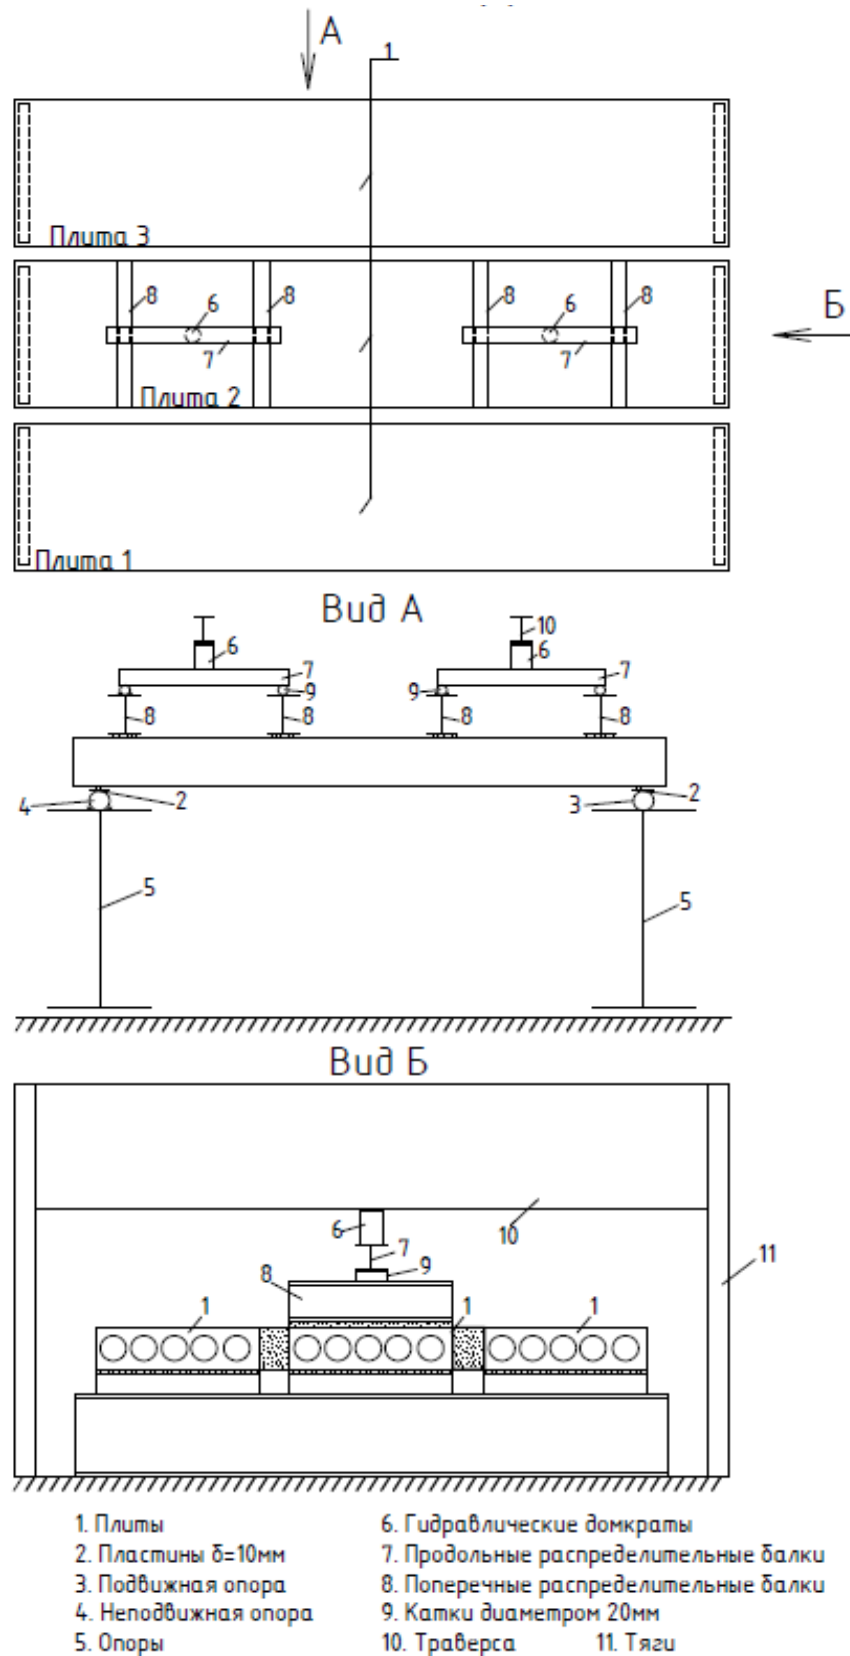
Схема испытания фрагмента перекрытия на неравномерную вертикальную нагрузку.
